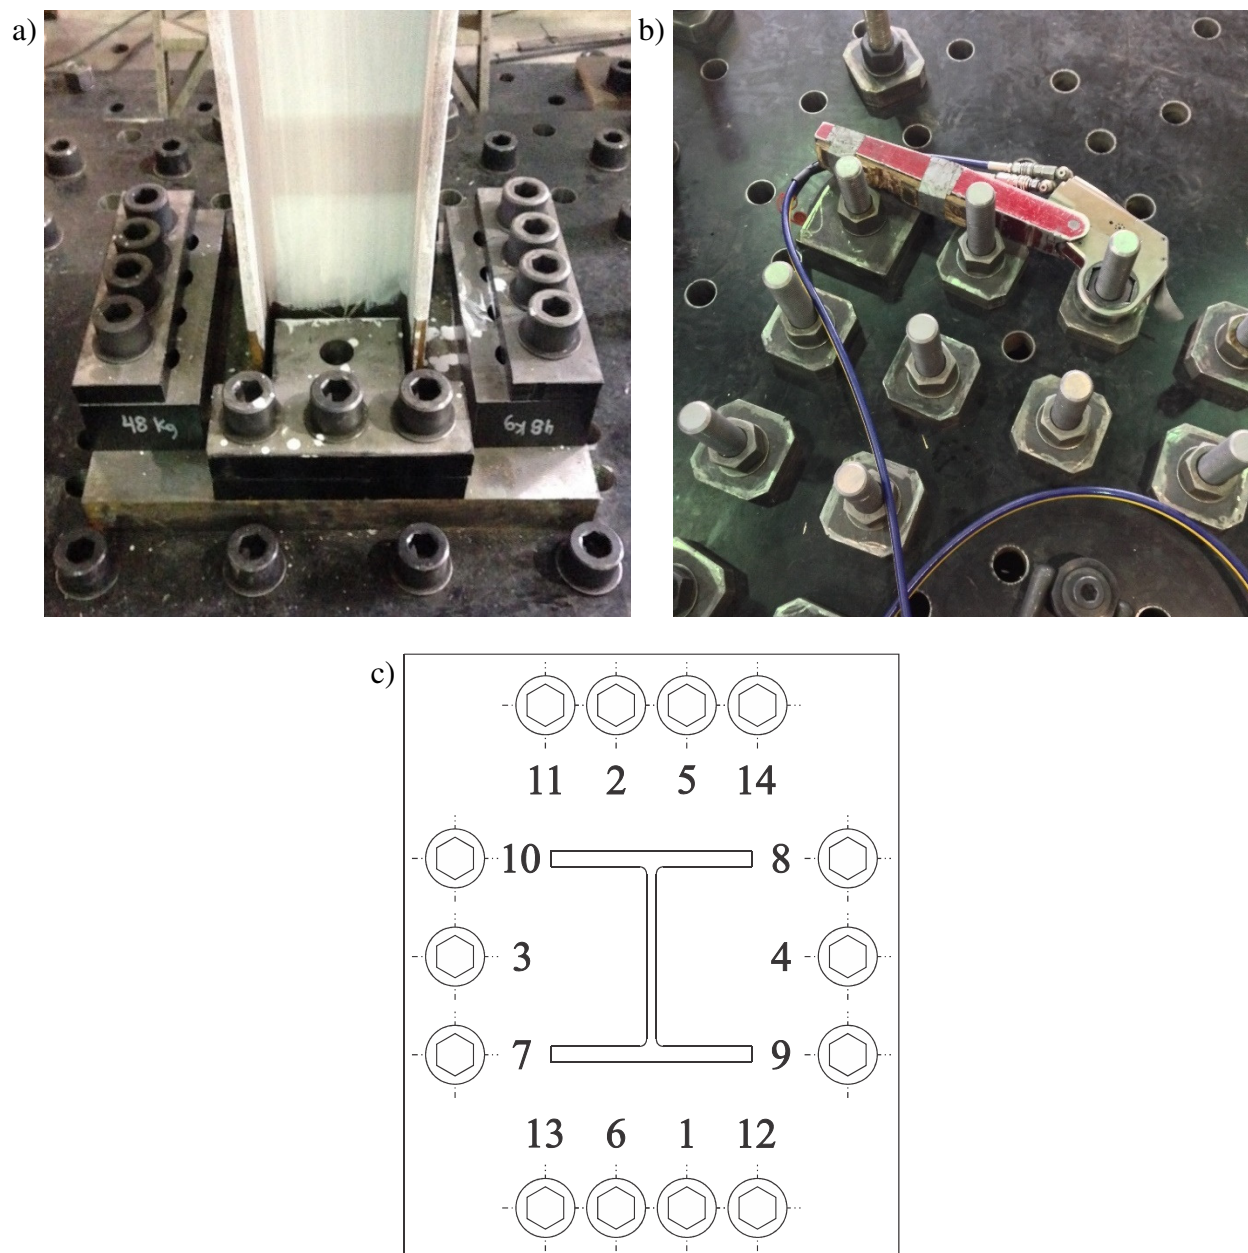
Assemblage des colonnes d'acier : a) plaques d'appuis ; b) visseuse hydraulique TX-8 ; c) protocole de serrage.
